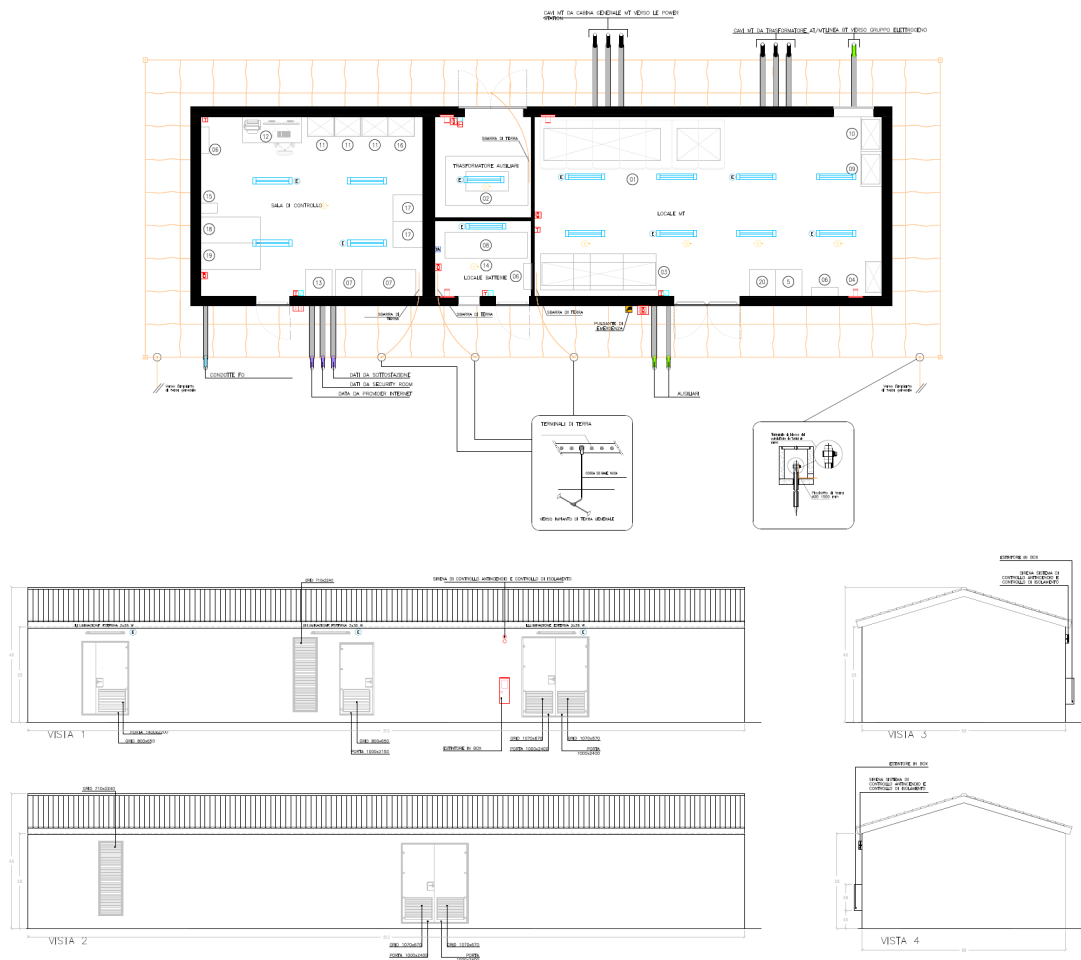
Pianta e prospetto del manufatto contenente la cabina MT
